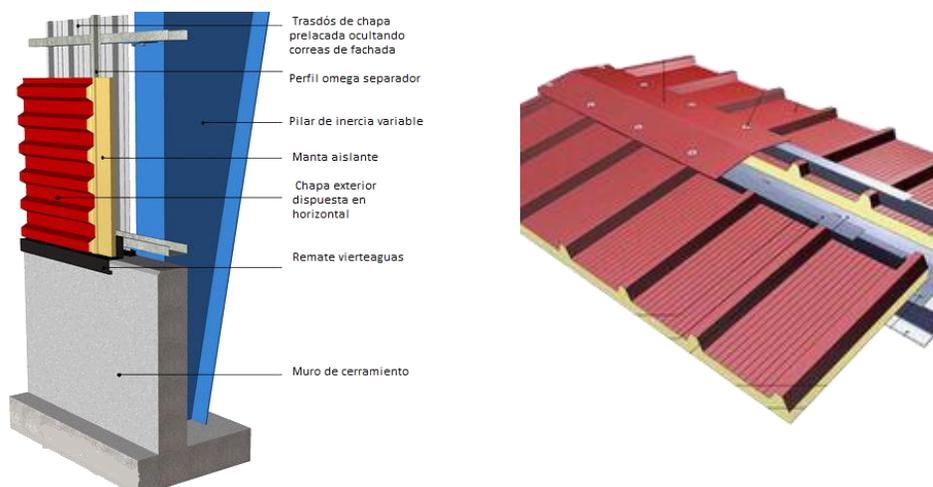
Detalle de instalación de panel en fachada y cubierta
